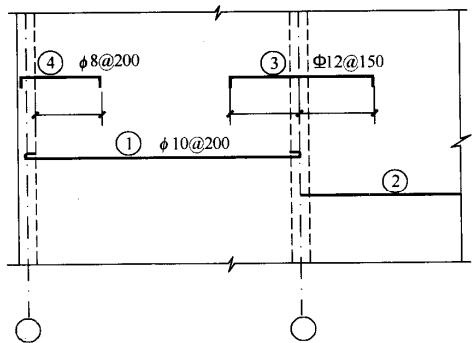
钢筋在楼板配筋图中的表示方法
